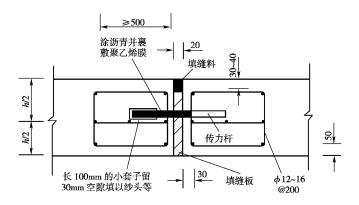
胀缝构造(尺寸单位 :mm)
